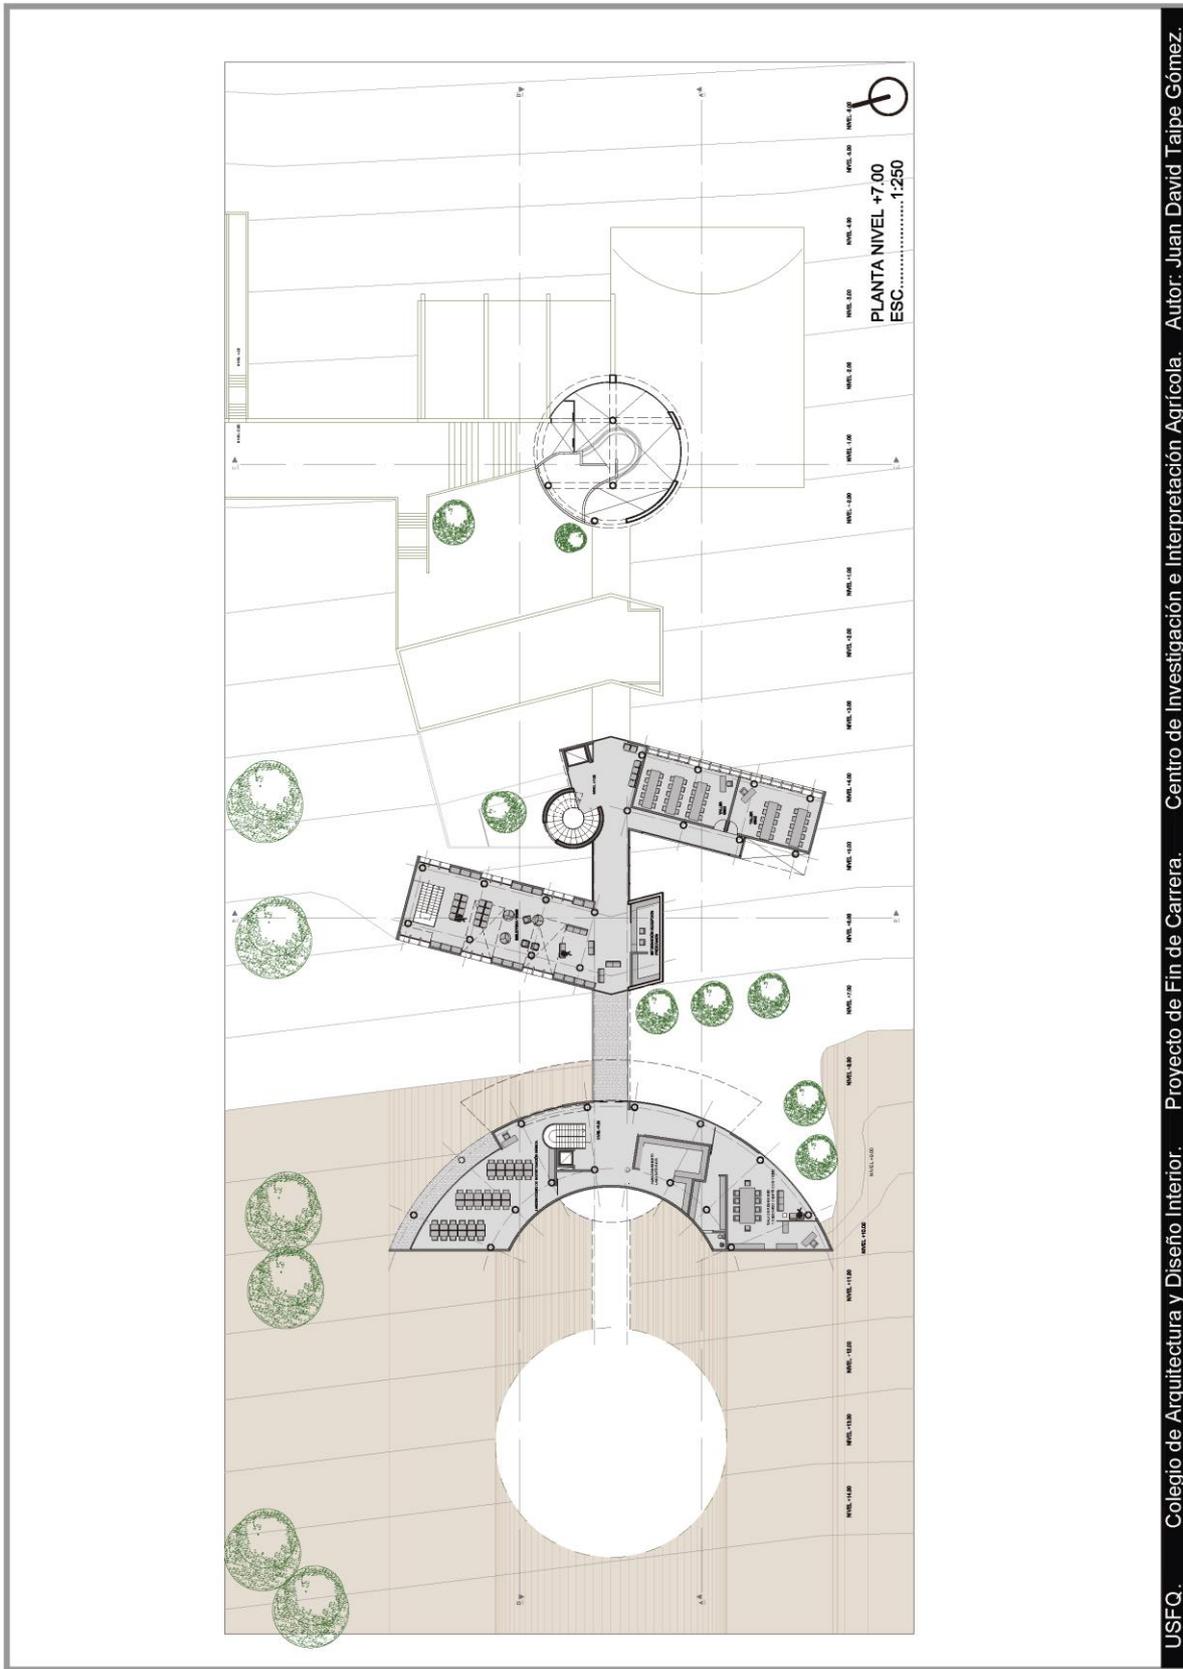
CIIA planta 3 (fuente: elaboración propia)
